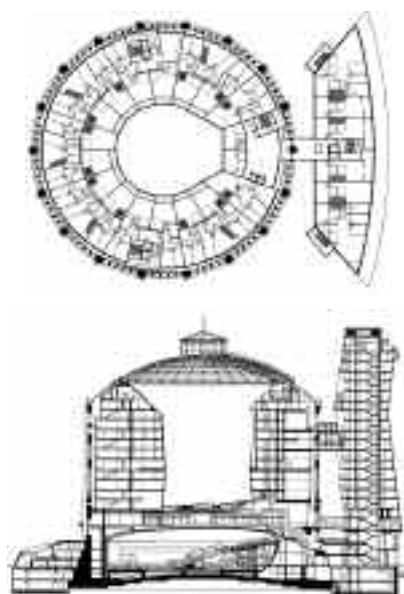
Gazometr A – elewacja [www.wiener-gasometer.at/de]
